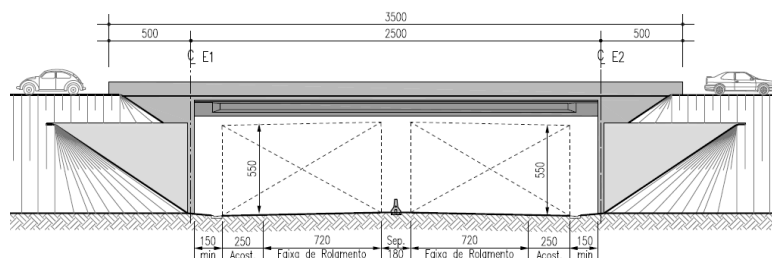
Passagens Inferiores com barreira rígida e 2 faixas por sentido. Elevação.
